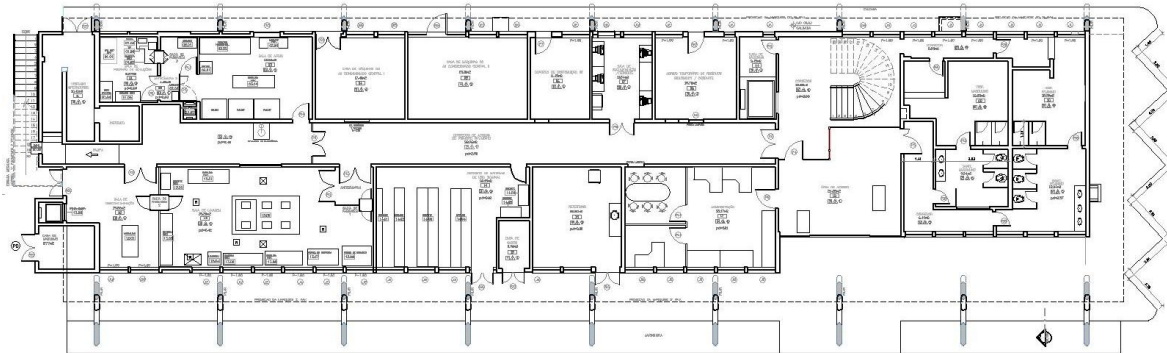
Laboratório da Febre Amarela: planta do 1º pavimento, 2016. Fonte: acervo técnico de BioManguinhos
